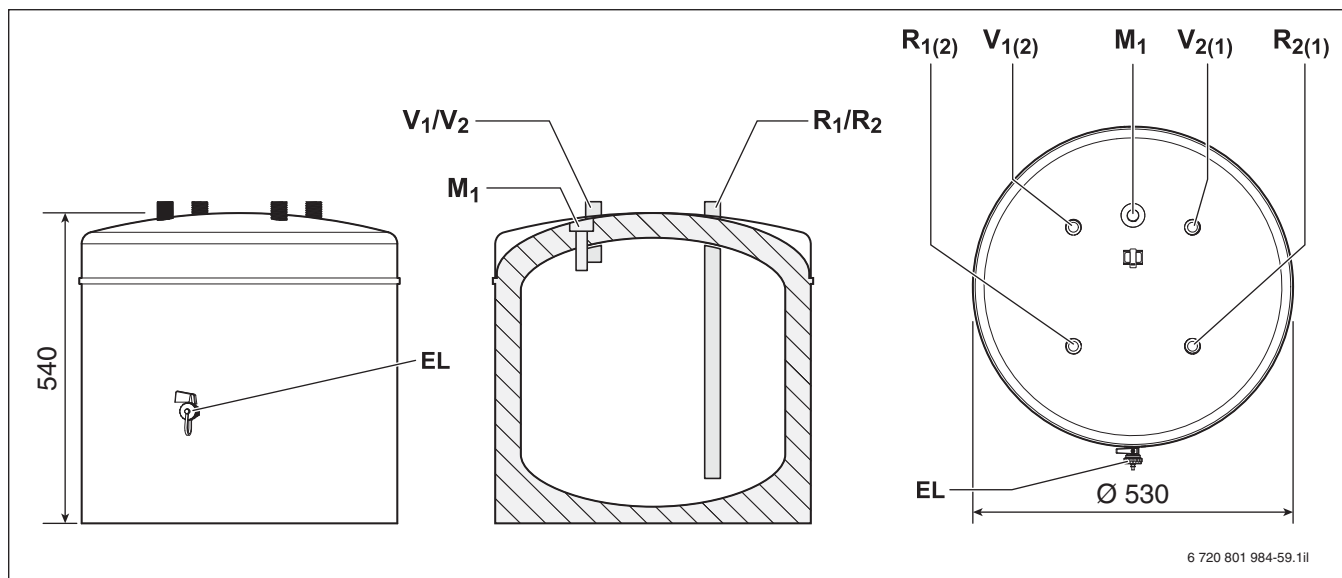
Bau- und Anschlussmaße PSWK 50 (Maße in mm)
